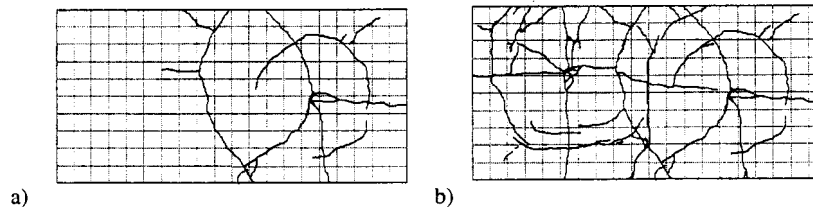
Cuadro de fisuración al terminar: a) Ensayo N°2; b) Ensayo N°3
